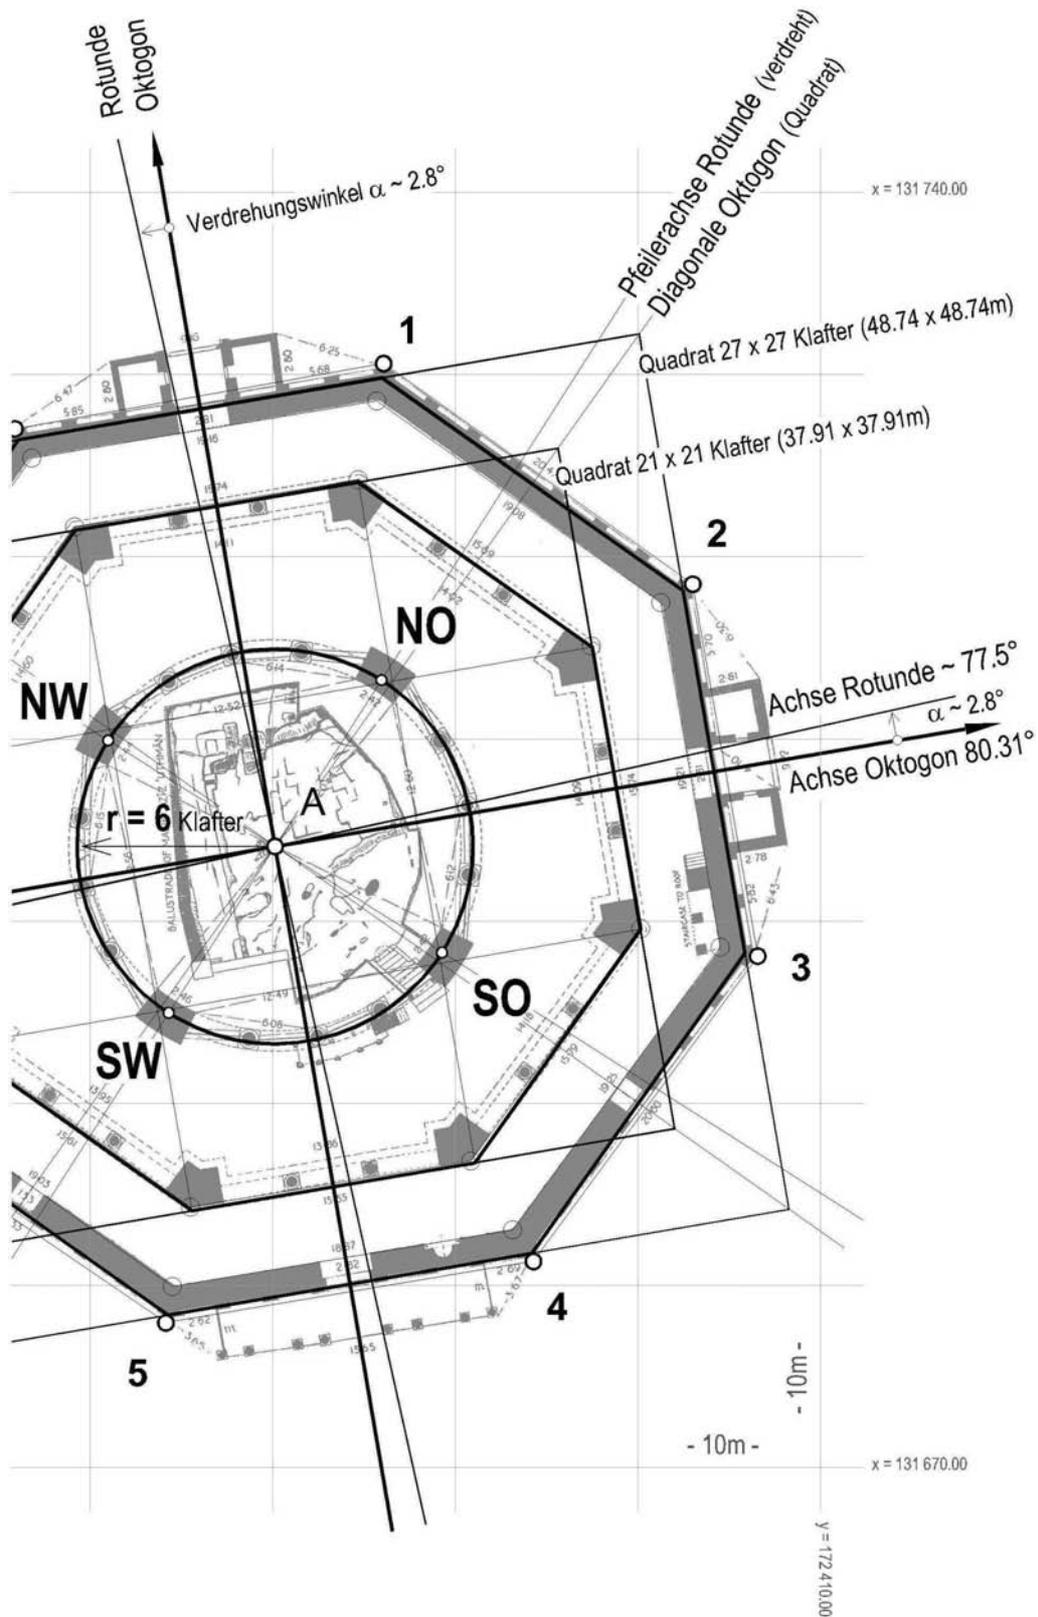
Gegenüberstellung Planung – Ausführung (Ausschnitt aus einem Detailplan M 1 : 200)¹⁰⁹
